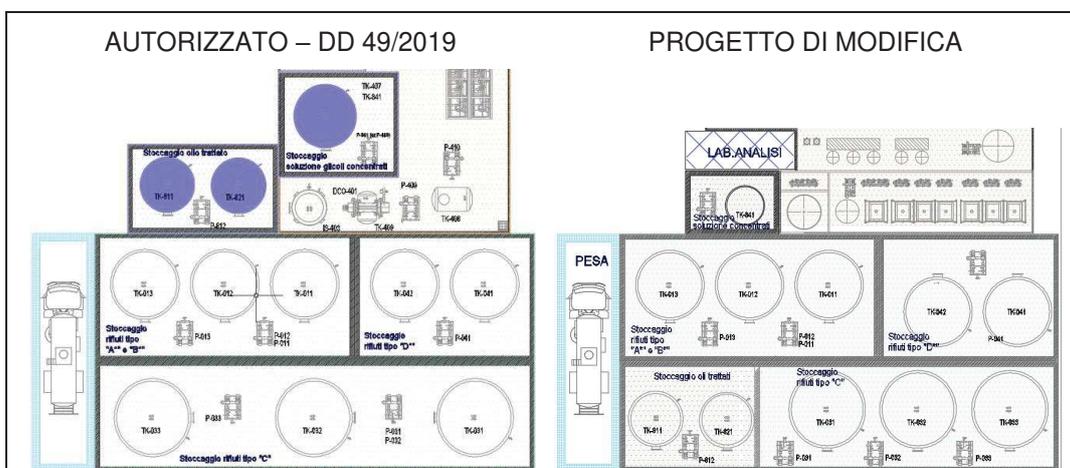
riconfigurazione del layout della Sezione 0 di stoccaggio.
